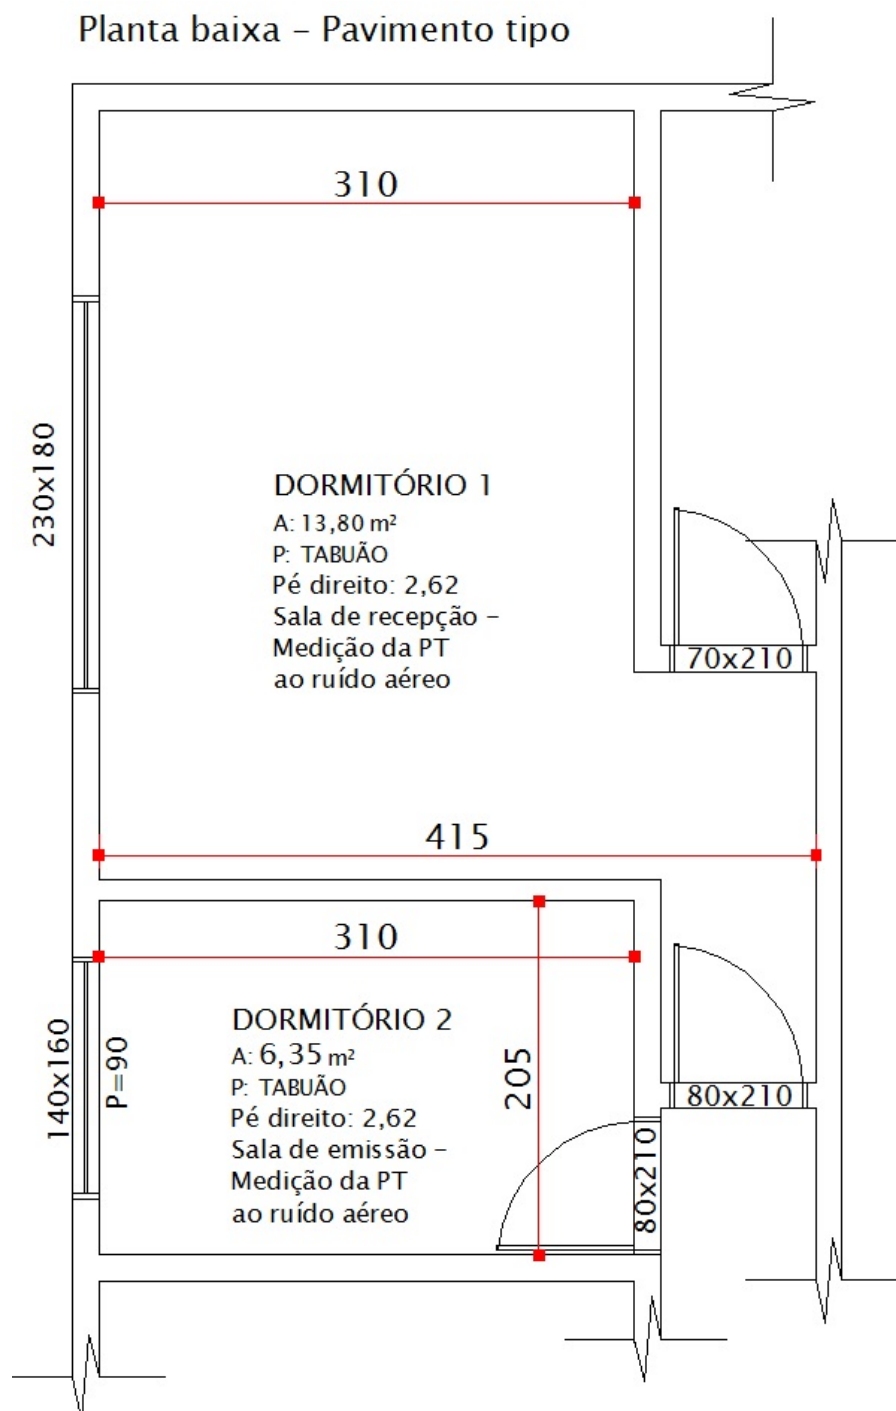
Planta baixa - pavimento tipo - 17-R8-A-TV
